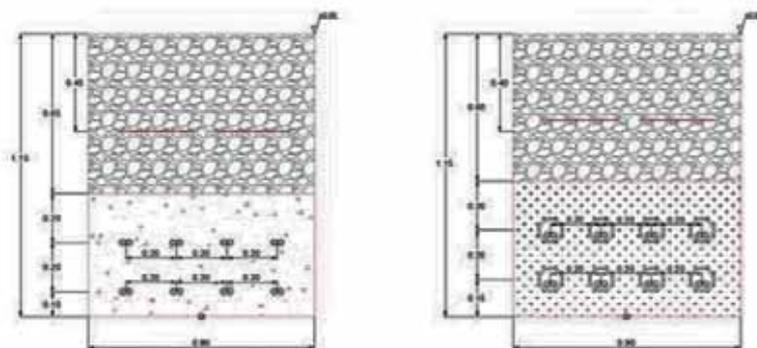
Detalle de zanjas para circuitos de Baja Tensión (izqda.) y de zanjas bajo camino (dcha.)
